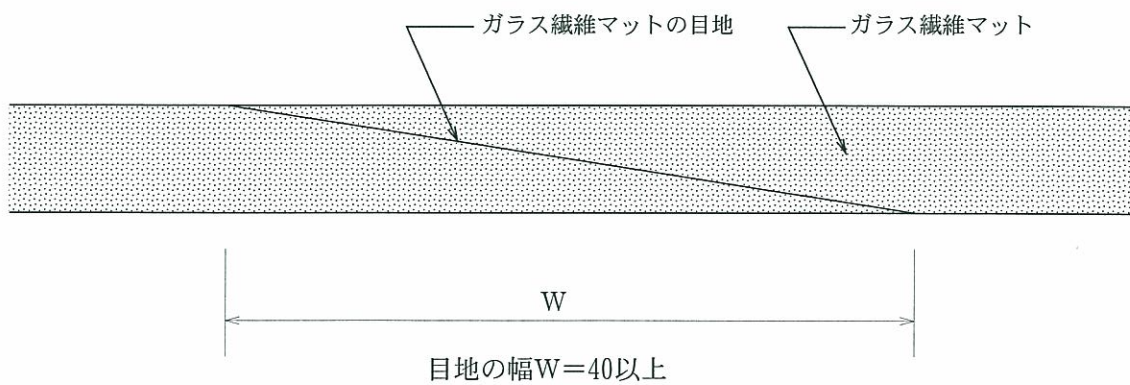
施工図 (防水層に用いるガラス繊維マットの目地断面)
